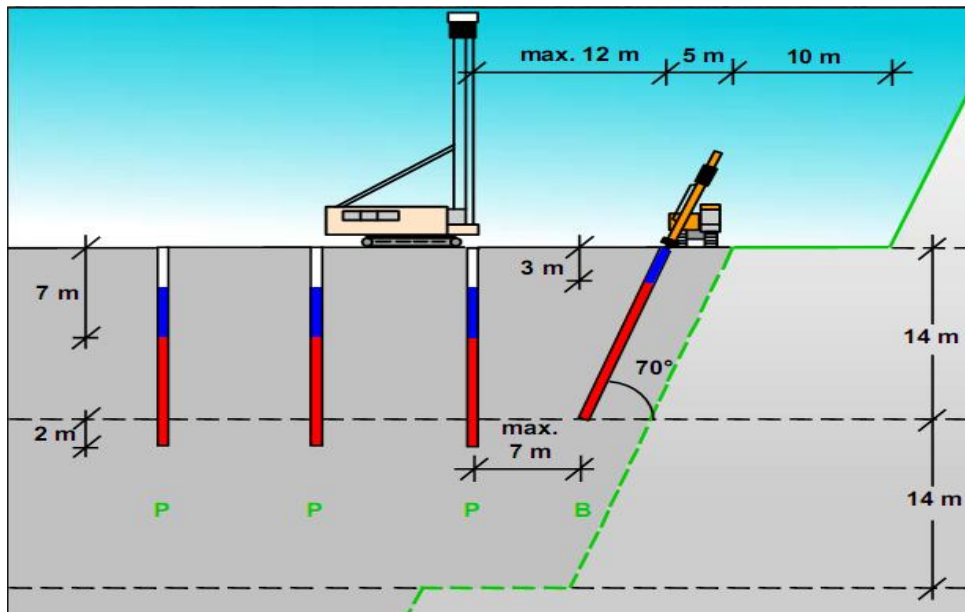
Plano de fogo de produção e amortecimento na primeira bancada.
